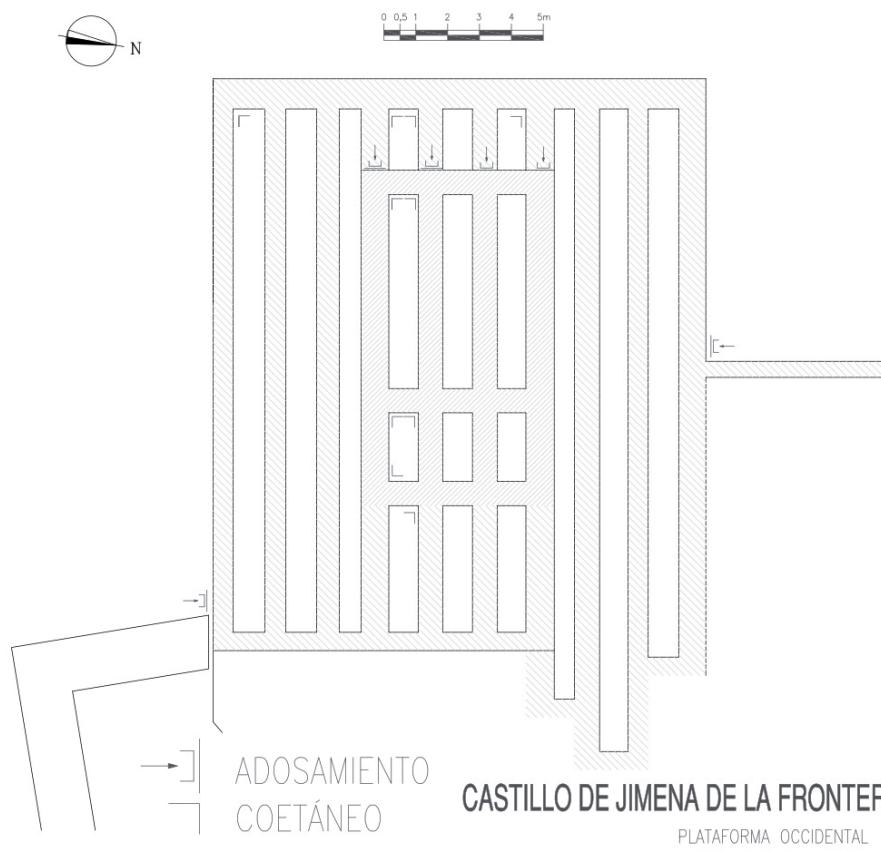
Plano de planta con sistemas de contactos entre los lienzos.
